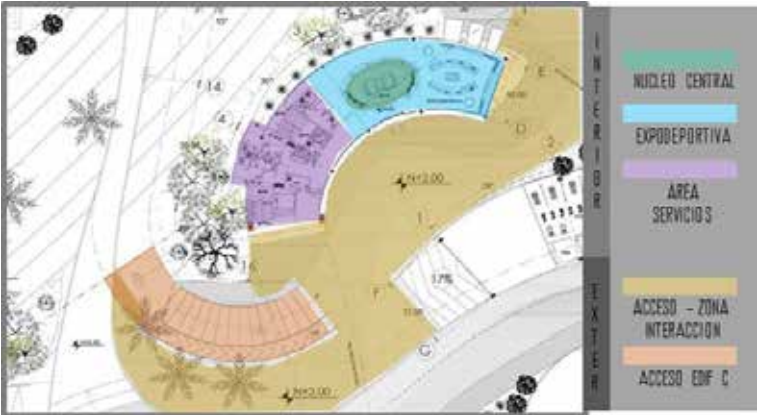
Edificio A, Planta Baja – Zona Pública. Fuente: Duarte De Andrade.
